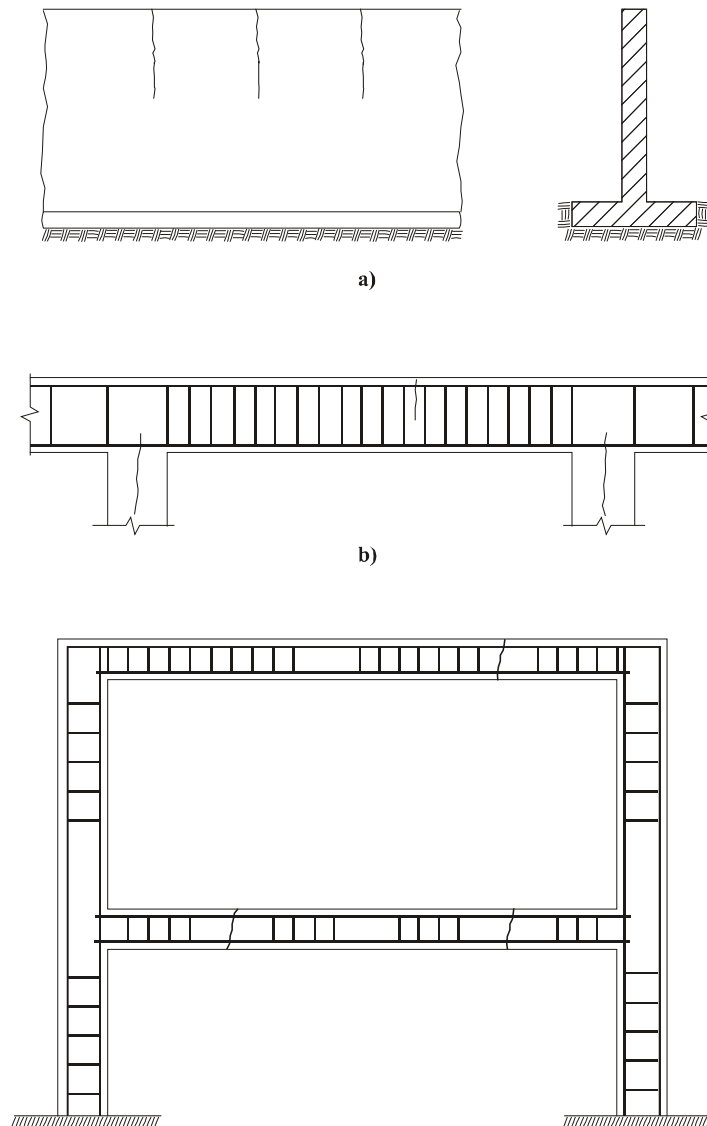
Fissuras de retração: a) muros de concreto apoiados no solo; b) vigas contínuas; c) pórticos
